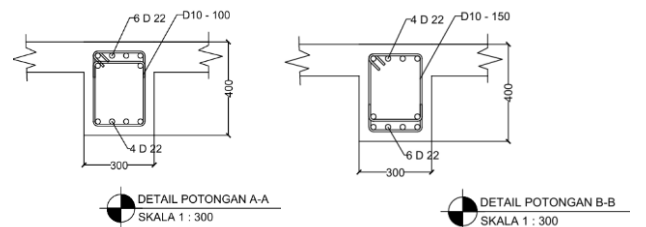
Potongan Penulangan Balok Induk Memanjang
